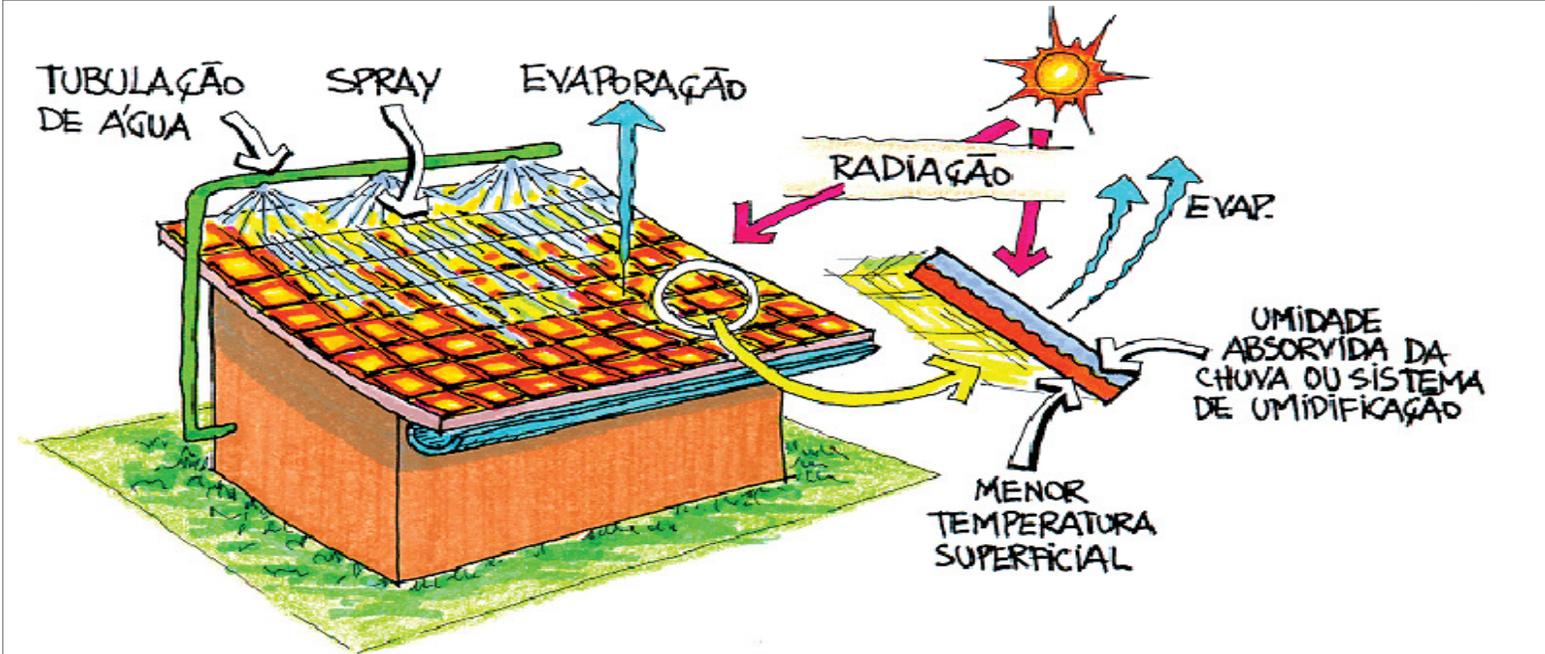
Evaporação na telha cerâmica e molhagem do telhado
